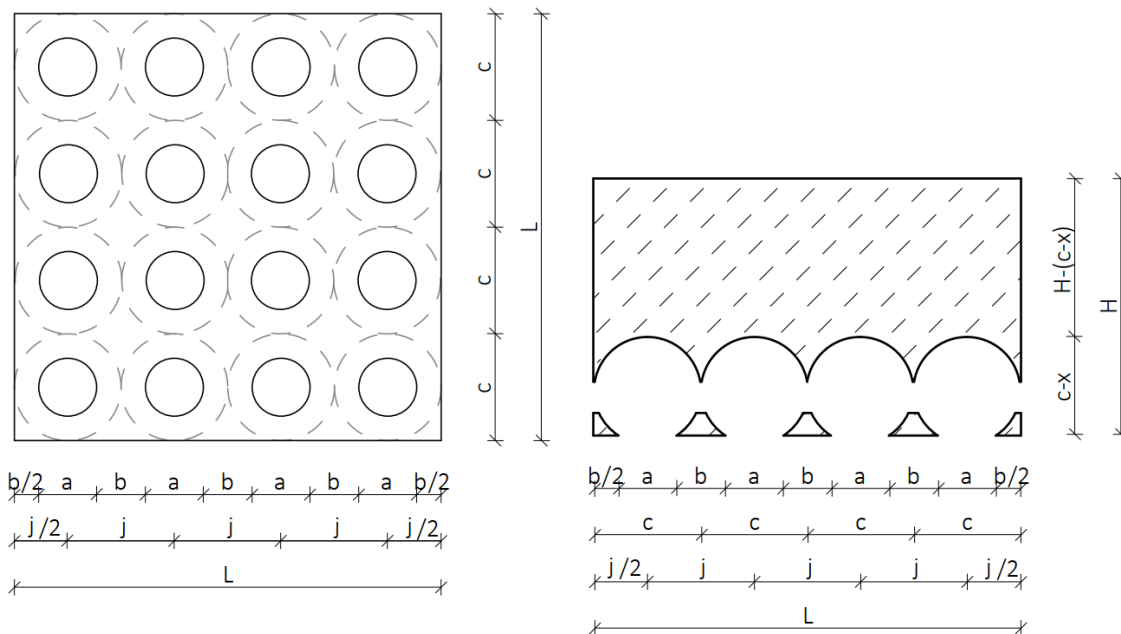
Betonkörper in Untersicht (li) und Schnitt (re)
